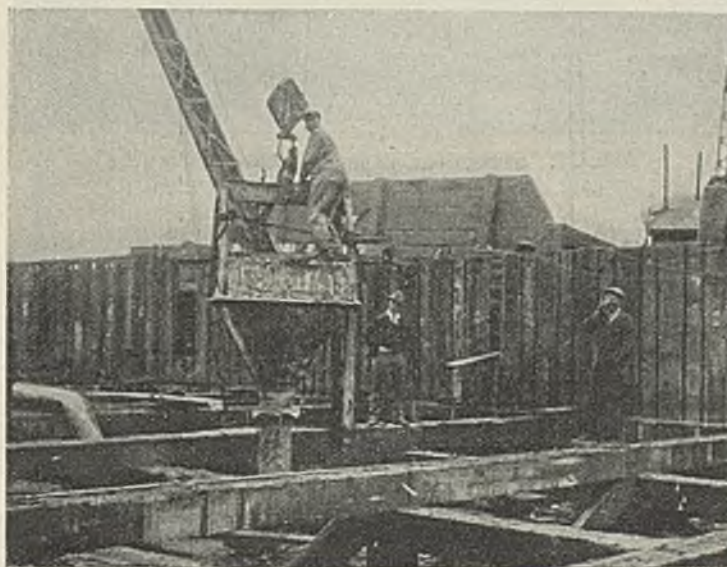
Einbringen von Beton unter Wasser mittels Schüttrohrs.
